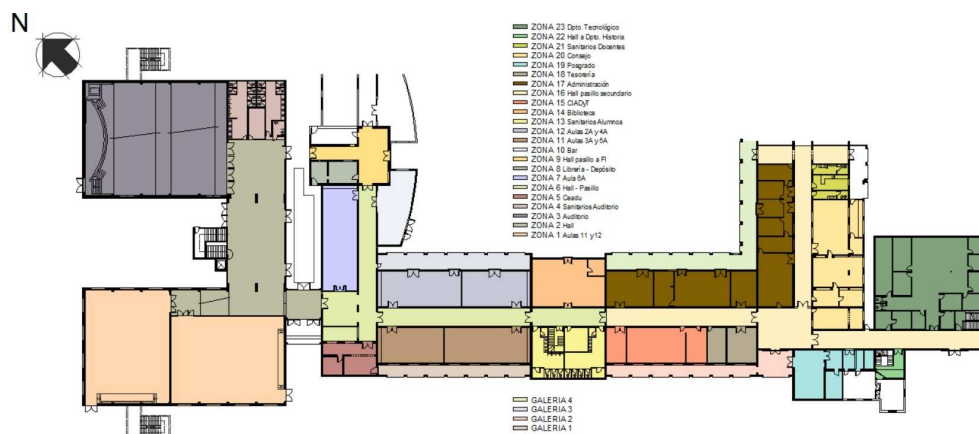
Zonificación Planta Baja – FAU – UNNE. Fuente: Coronel, C. et al, 2011.
